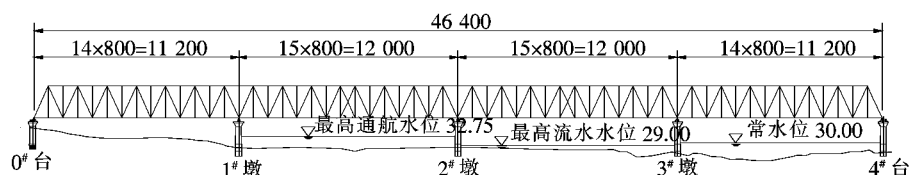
某黄河特大桥立面布置图(除标高单位为m外,其余单位:cm)
